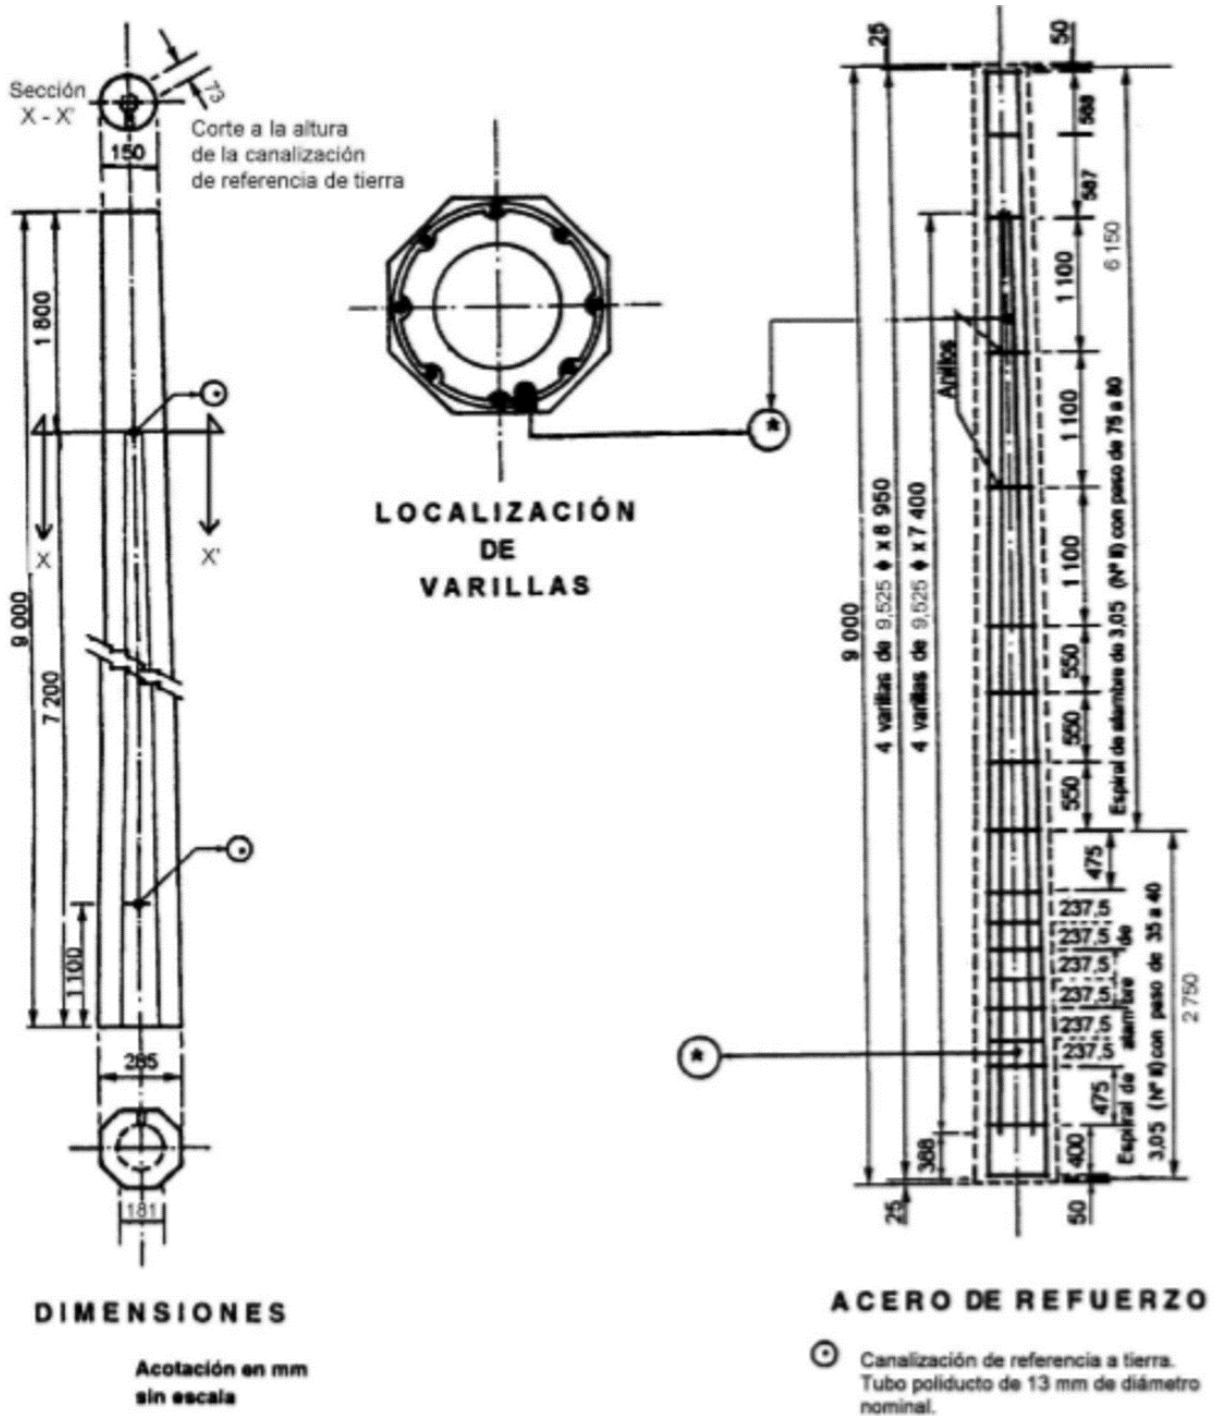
Planos de especificación para postes de concreto reforzado PCR- 9C-400 de 9 metros.
